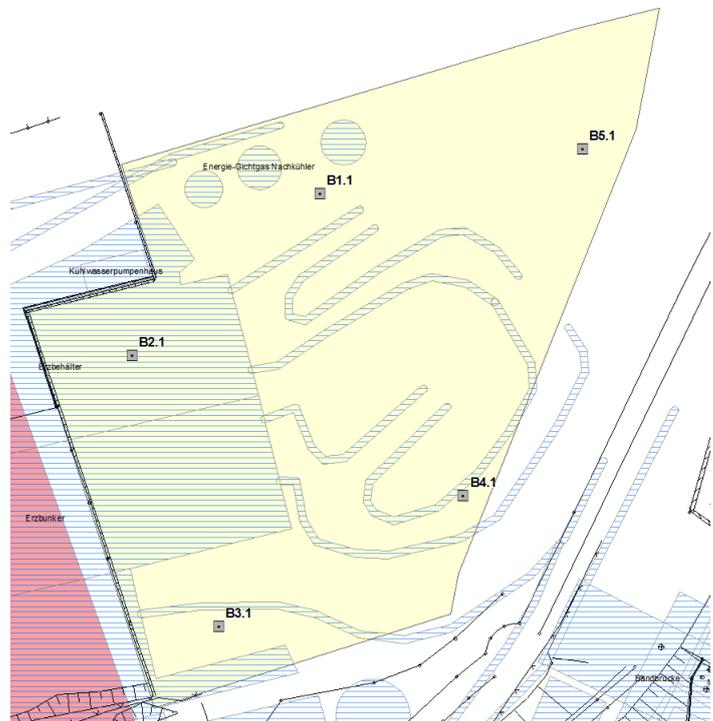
Lageplan der Untersuchungspunkte B1.1 – B5.1 zur Erkundung der oberflächennahen Böden im Bereich der Teilfläche Silbernagel
